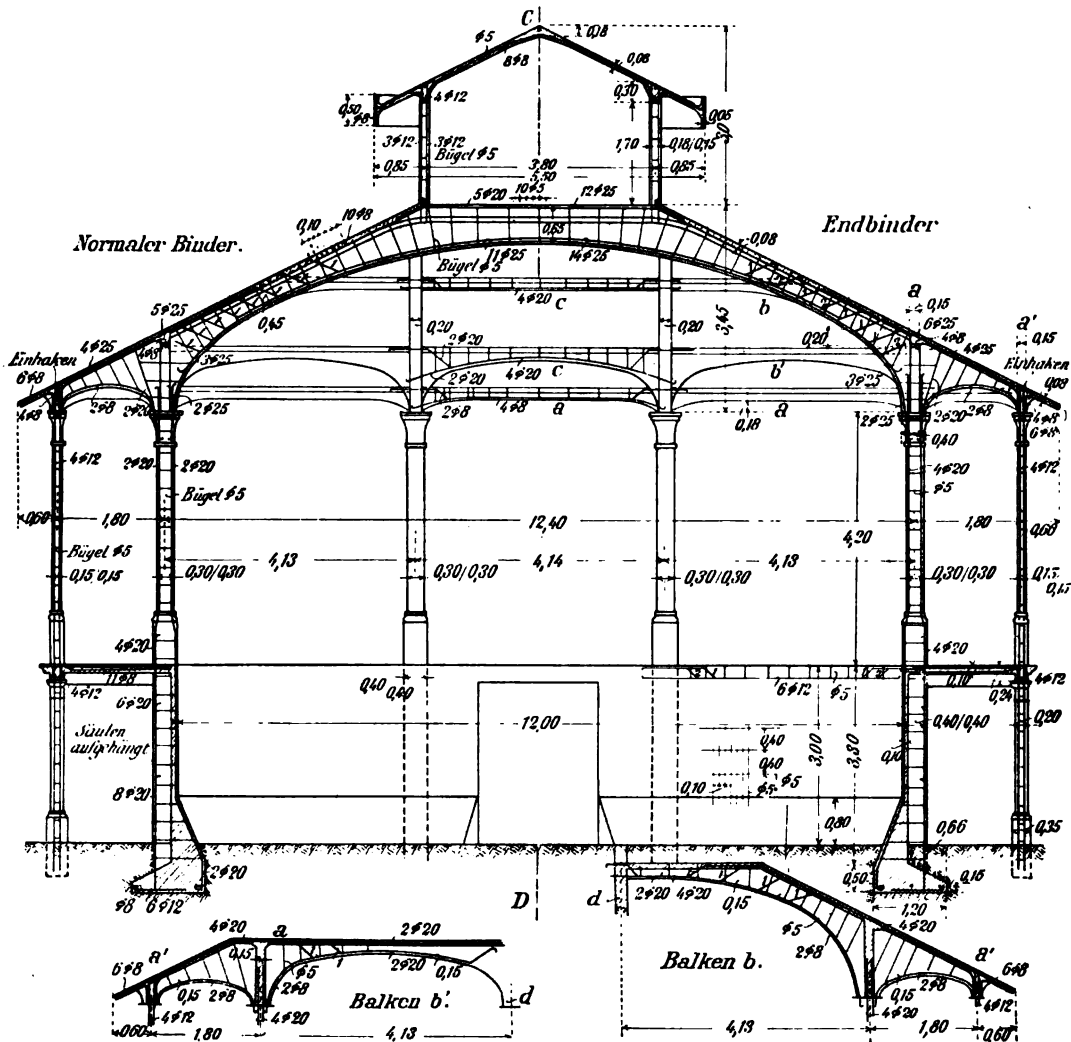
bis 373. Querschnitt AB (s. Abb. 374 u. 376) der Reithalle in Dresden.
